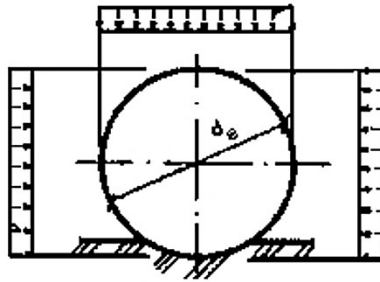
Схема навантажень на трубопровід від тиску ґрунту і навантажень, що передаються через ґрунт
